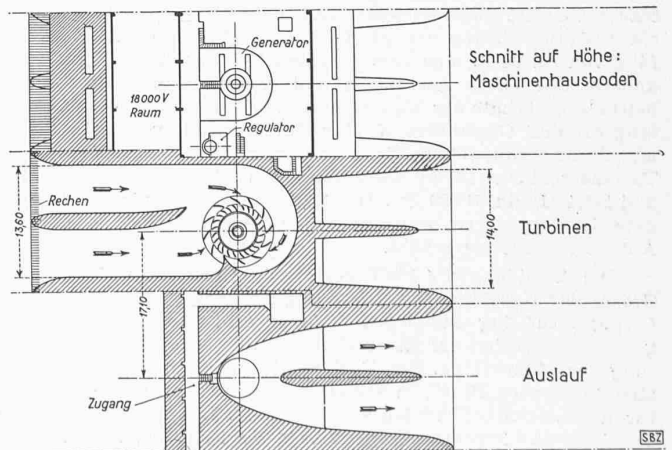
Horizontalschnitte des Maschinenhauses. — 1 : 800
